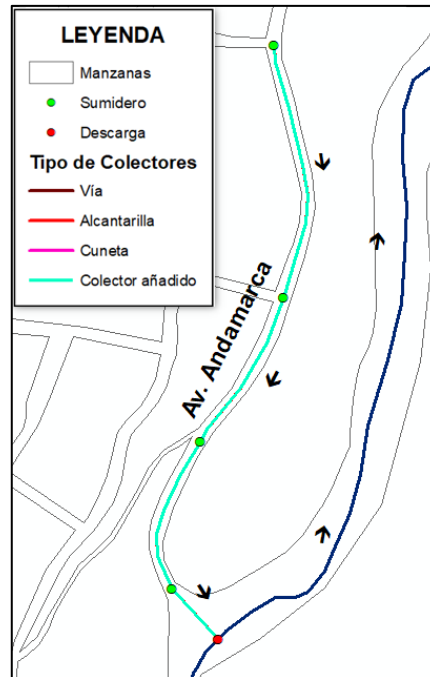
Alcantarilla añadida en Av. Andamarca
